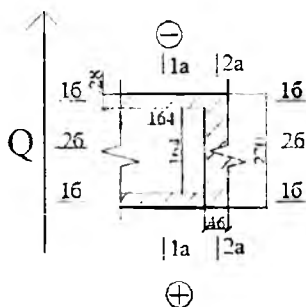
Железобетонная плита с эквивалентными квадратными пустотами
